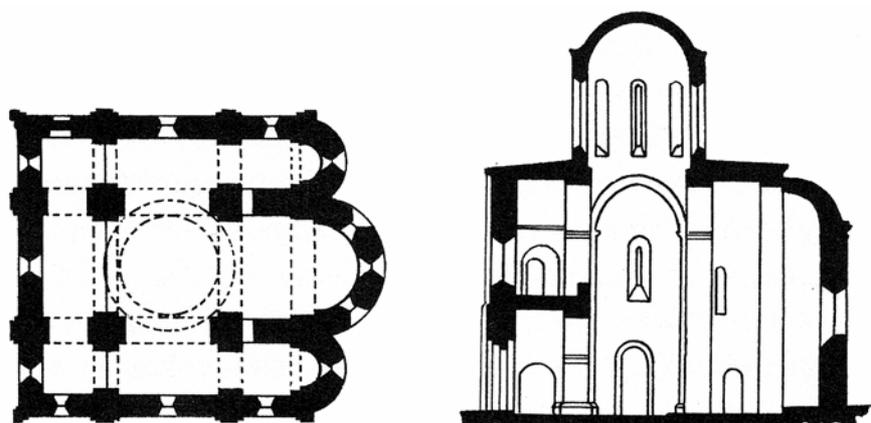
Verklärungskathedrale in Pereslawl Zalesskij. Grundriss, Längsschnitt
